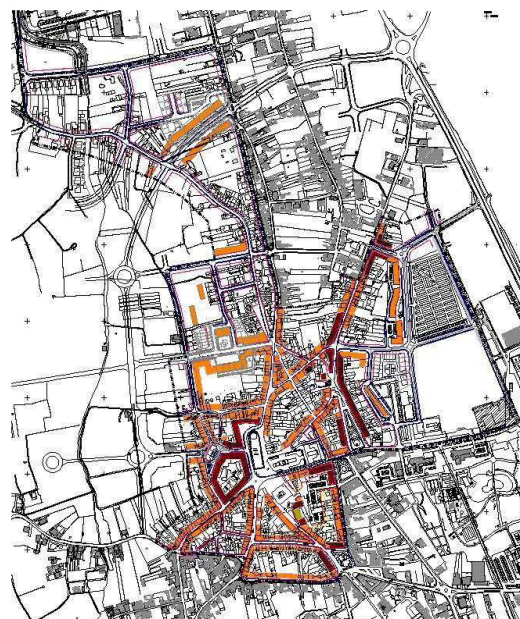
Planta de implantação do PP de Alinhamento e Cérceas da Cidade de Cantanhede
